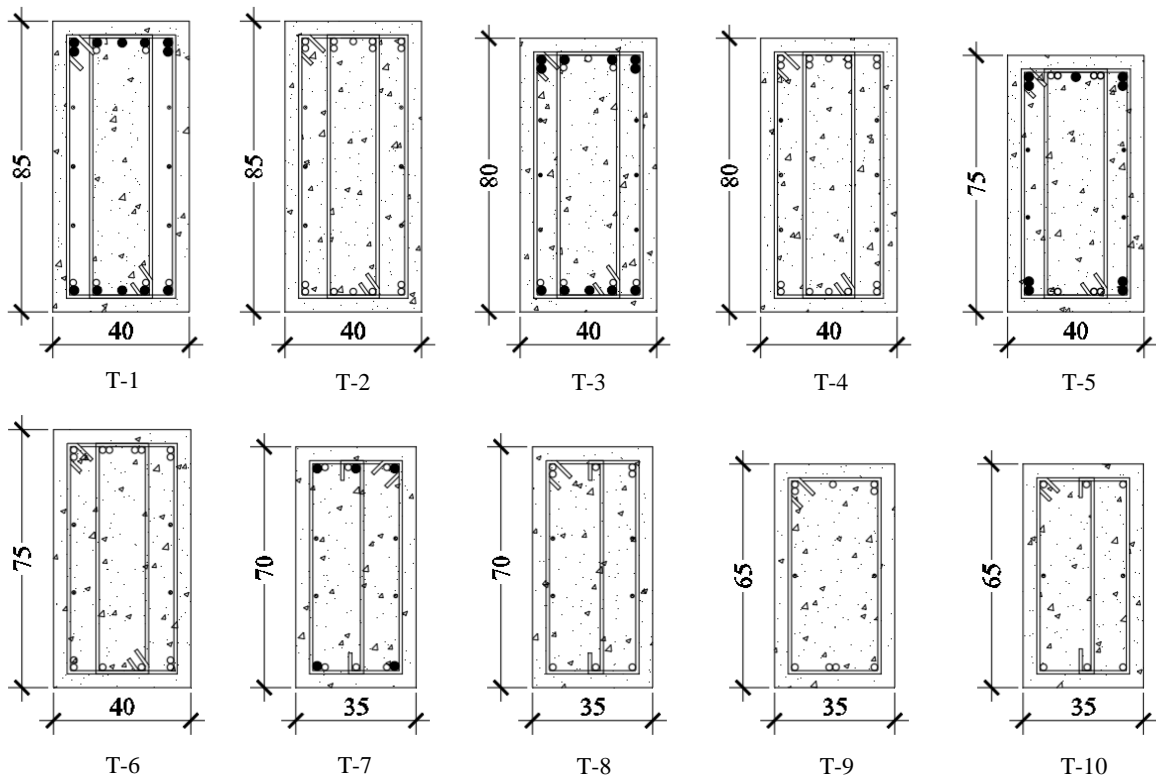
Secciones de traves de traves del edificio de 15 niveles.
